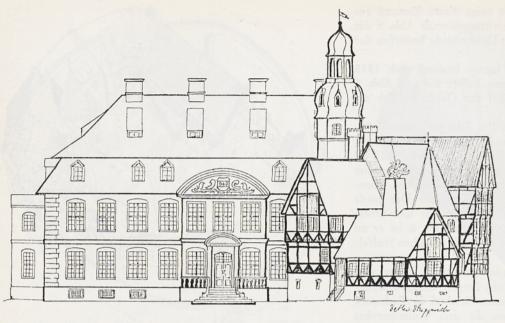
Wahrscheinliche Nordansicht des Schlosses Gartow im Jahre 1712. Vor dem Mittelteil der Barock-Anlage steht als Interimsbau ein Rest der alten Schloßanlage mit dem Renaissance-Treppenturm, dem Fachwerkbau ganz rechts von 1688 und den beiden anderen Fachwerkteilen von 1698/
